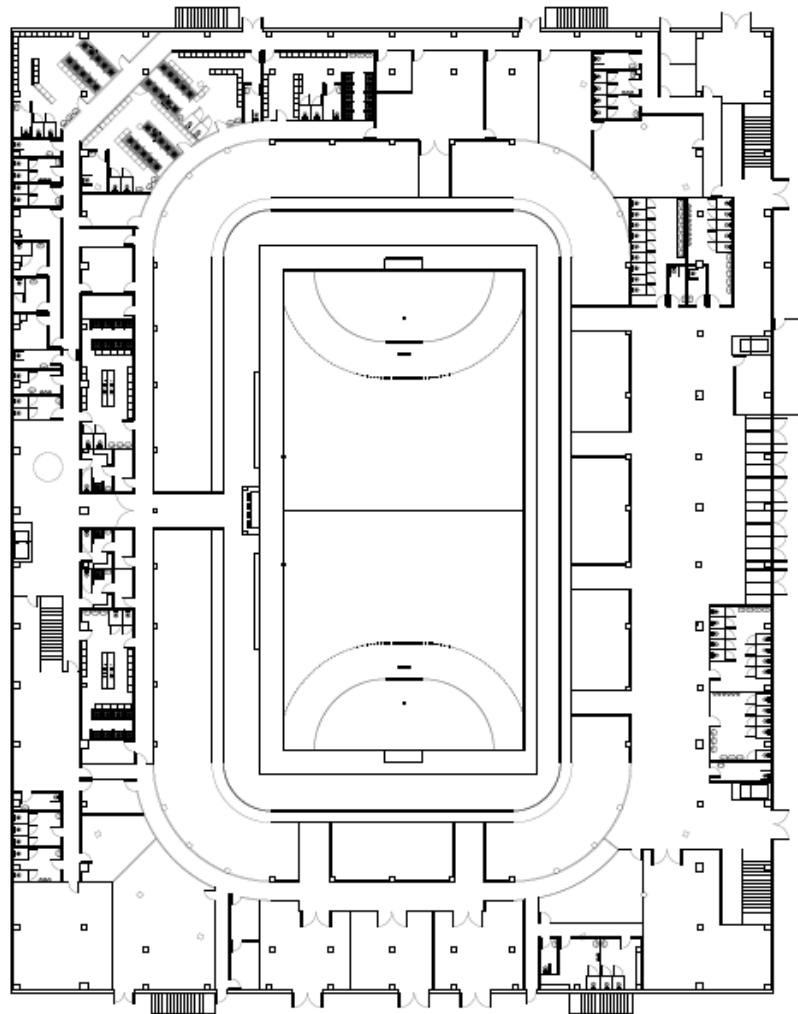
1 – Vista en planta de la distribució de la planta baixa.
